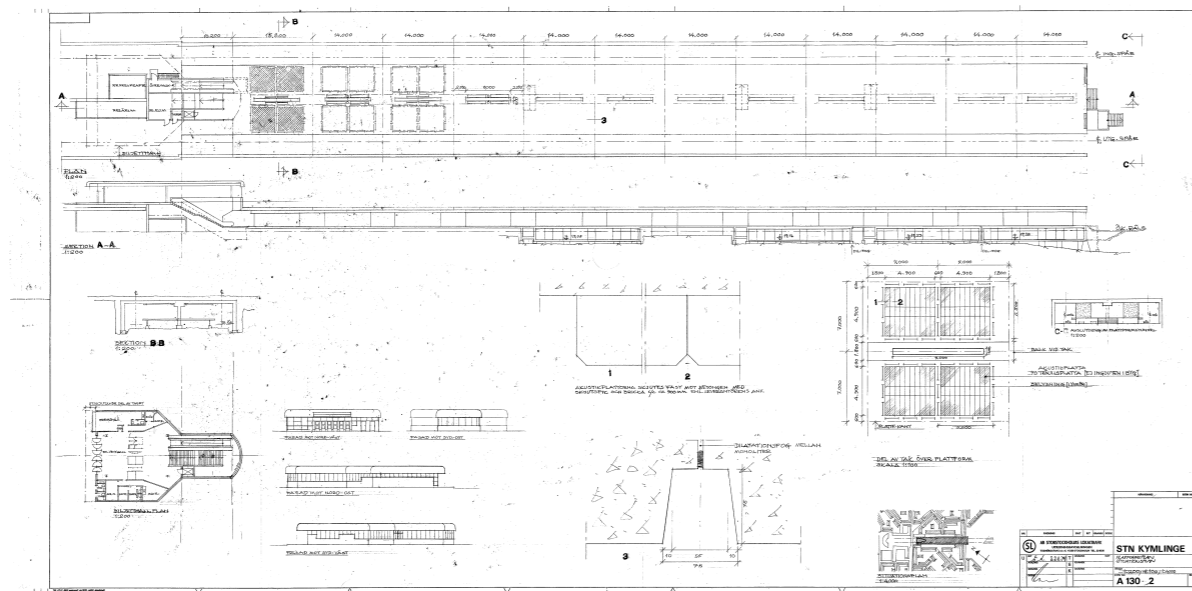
Ritningar över tunnelbanan. Plattformsplan och situationsplan (t.v). Planer, fasader och sektioner över planerad tunnelbancuppgång i norr änden av plattformen. (t.h.) © Vasakronan.
